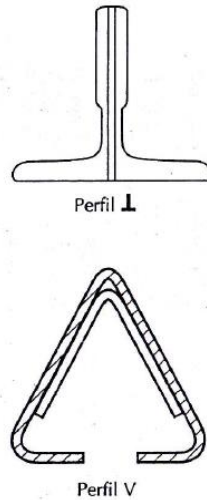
Perfiles para rieles guía de los elevadores
